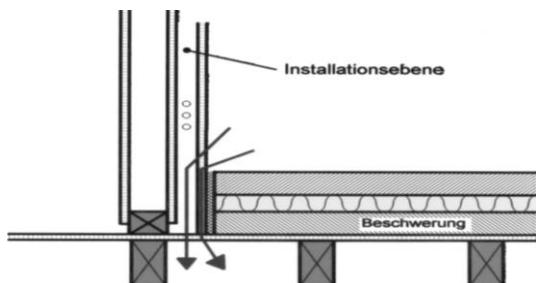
Decke mit sichtbarer Balkenlage und Wänden mit Installationsebene.
